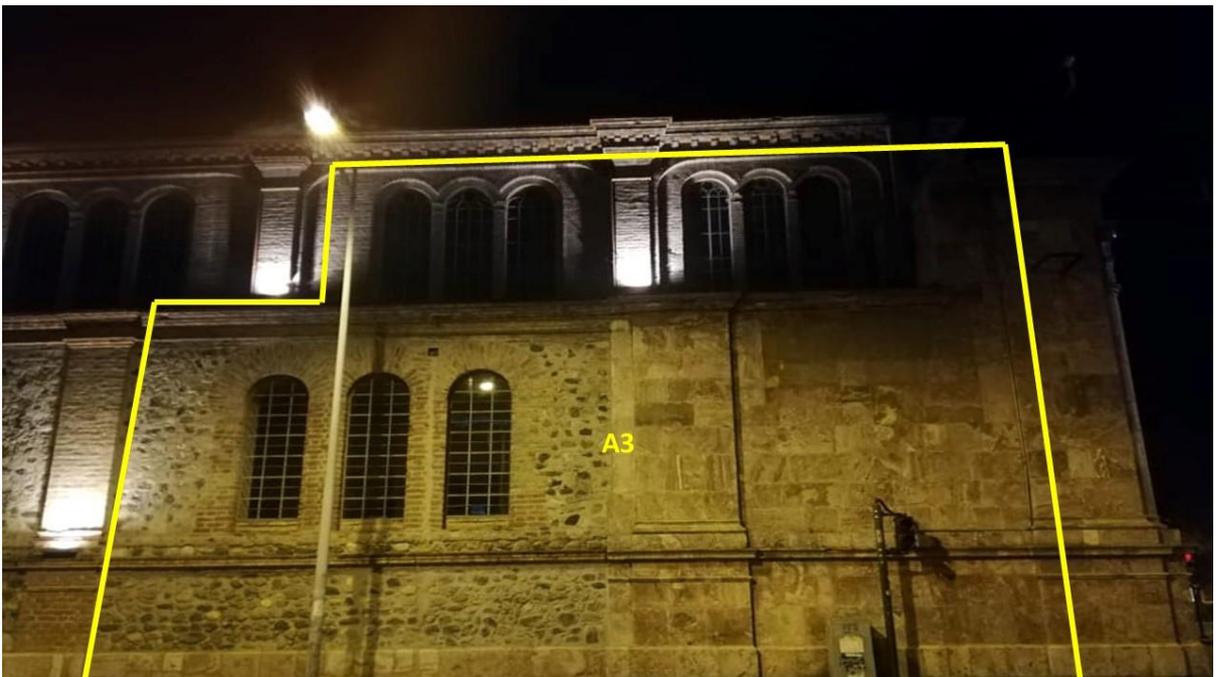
Sección de la fachada lateral 3 iglesia San Blas. [Autores]
